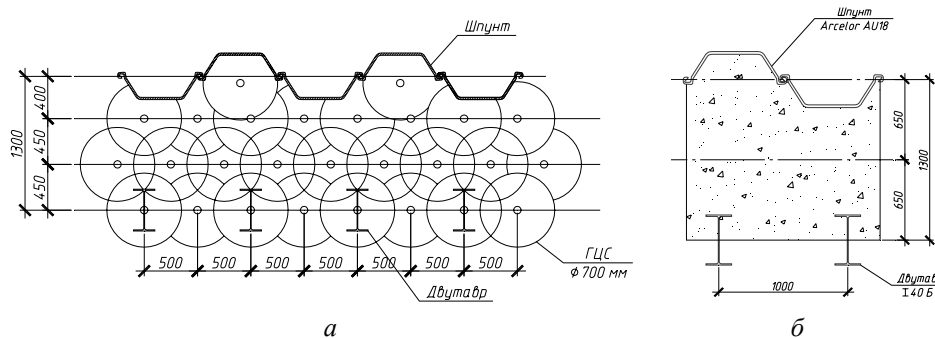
Конструкция комбинированного ограждения из металлического шпунта и грунтоцементных свай (а) и расчетная схема (б)
